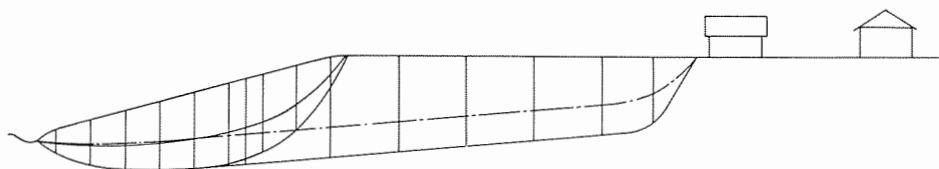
Plan och profil i Baastad. (Från Aas, 1982.)
